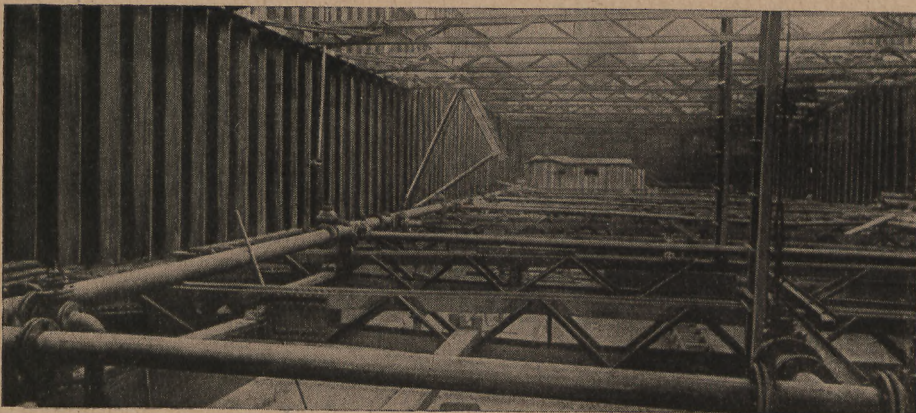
Untergrundbahn-Baugrube mit Fachwerkstahlstützen abgesteift
